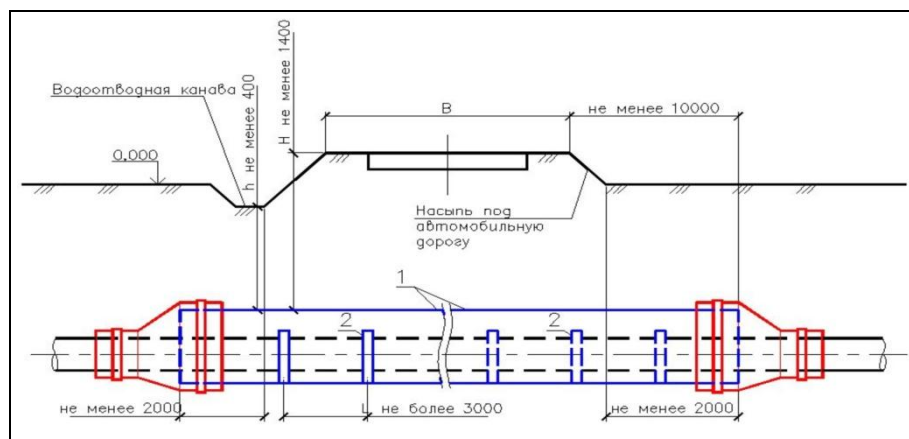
Схема укладки трубопровода на переходе через автодорогу
